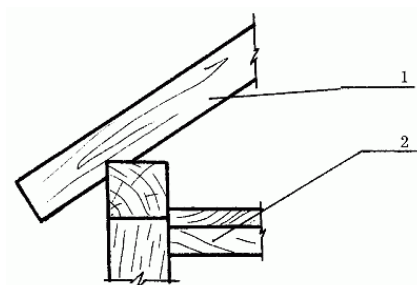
Наслонные стропила в деревянных каркасных зданиях: 1 – балка перекрытия; 2 – стропильная нога
